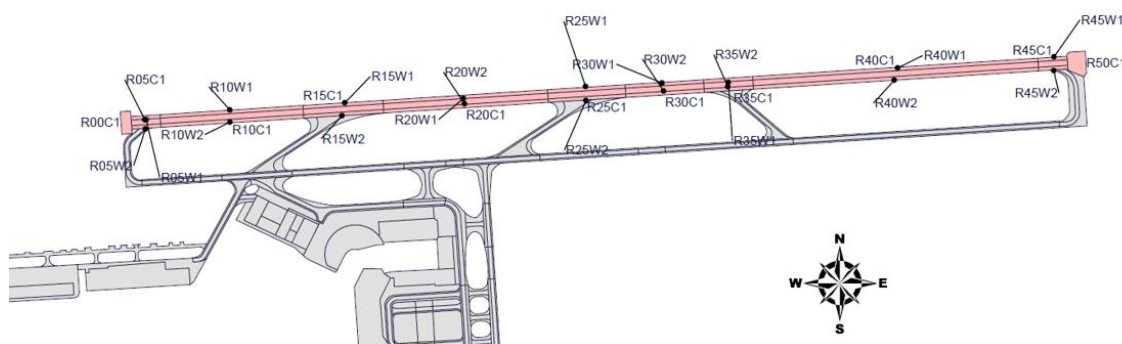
Localização das seções avaliadas da pista 11L-29R, em planta
